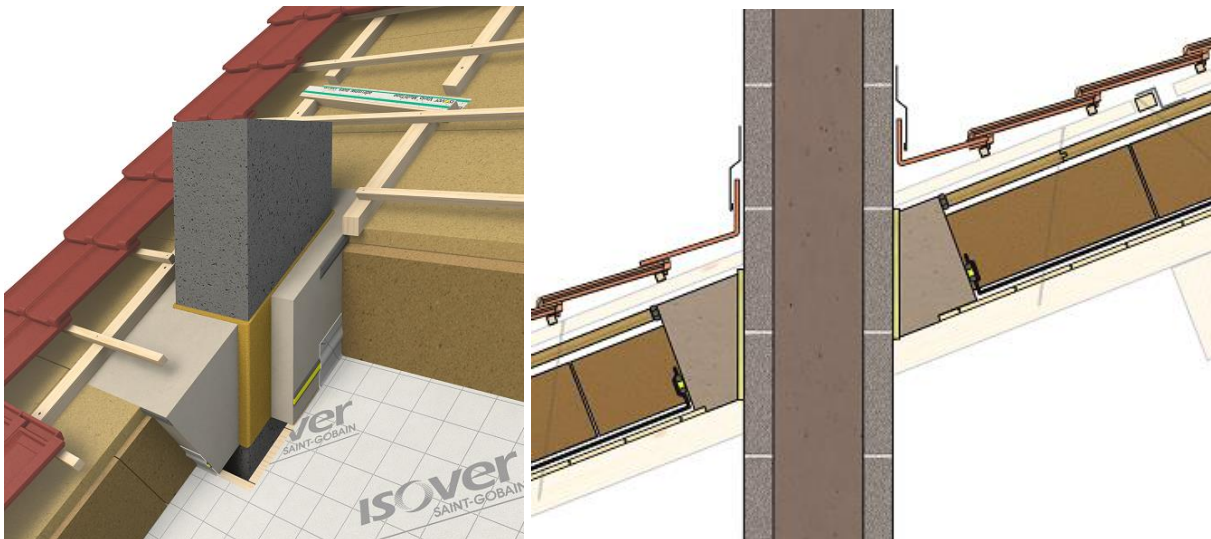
Cas d'un conduit sans kit isolé sous avis technique (conduit maçonné ici)
